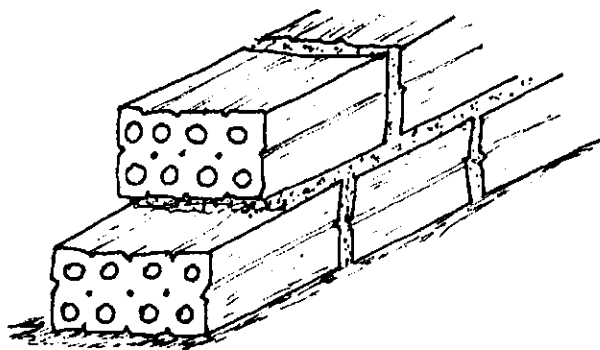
Execução de alvenaria de 1 vez, utilizando tijolos furados.
